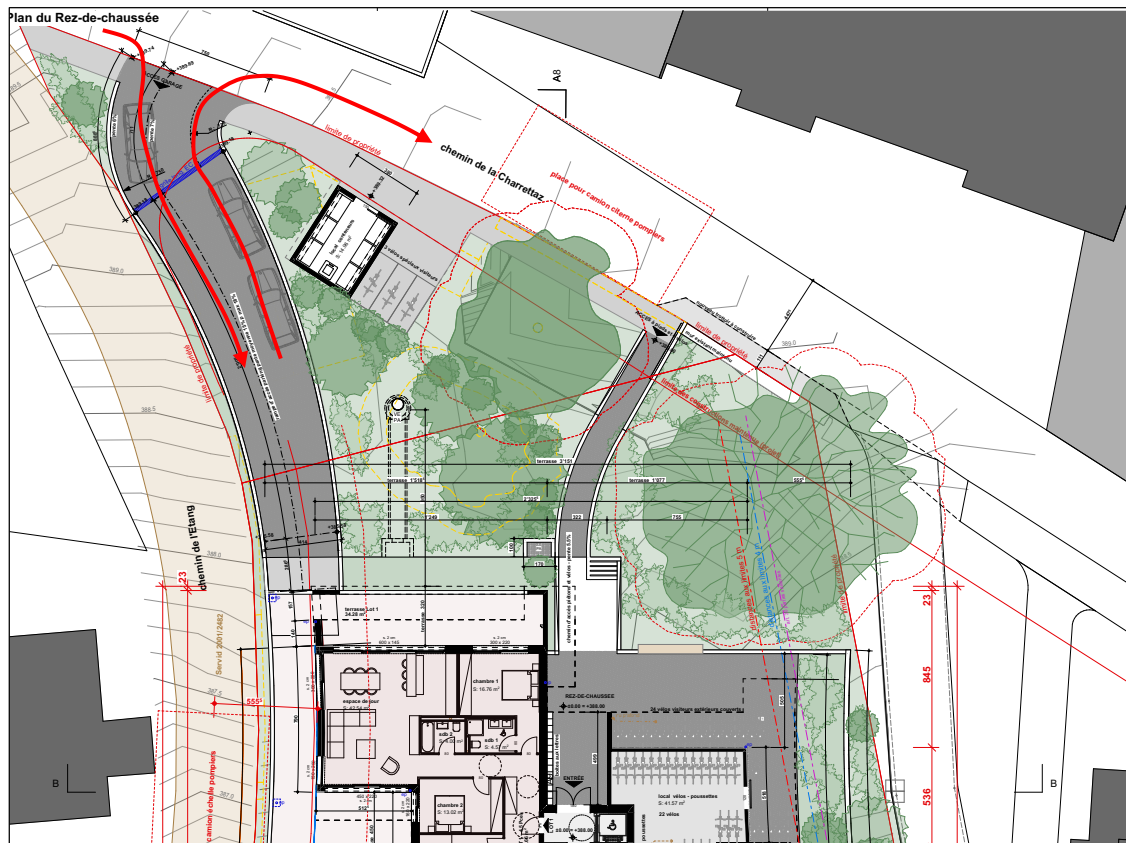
Raccordement du parking souterrain projeté au chemin de la Charrettaz (plan: archilab)
